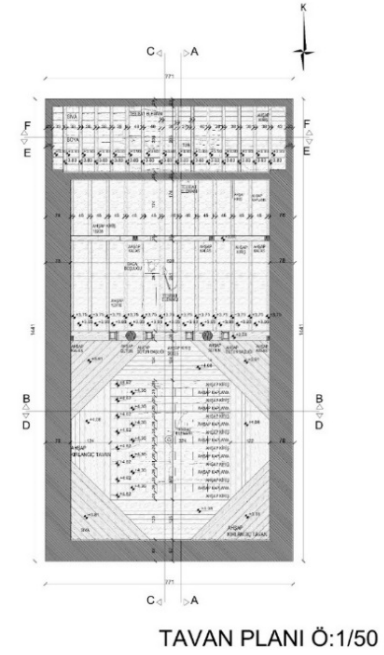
Cami Tavan Planı (Demir group / Mnd design)
